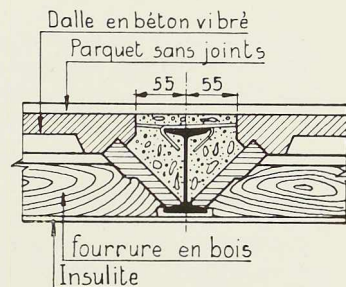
Coupe dans le plancher au droit d'une solive enrobée.
